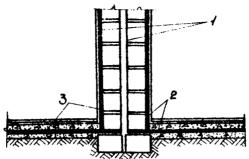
Устройотво гидроизоляции отен І-киримчная кладка; 2-гидроизоляция из полимербитумной мастики; 3-штукатурка из полимерцементного раствора
